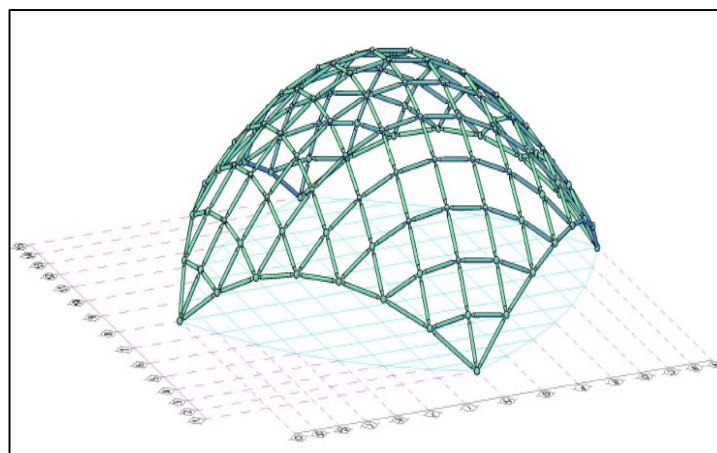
Modelado BIM en 3D, del cascaron reticulado final.
